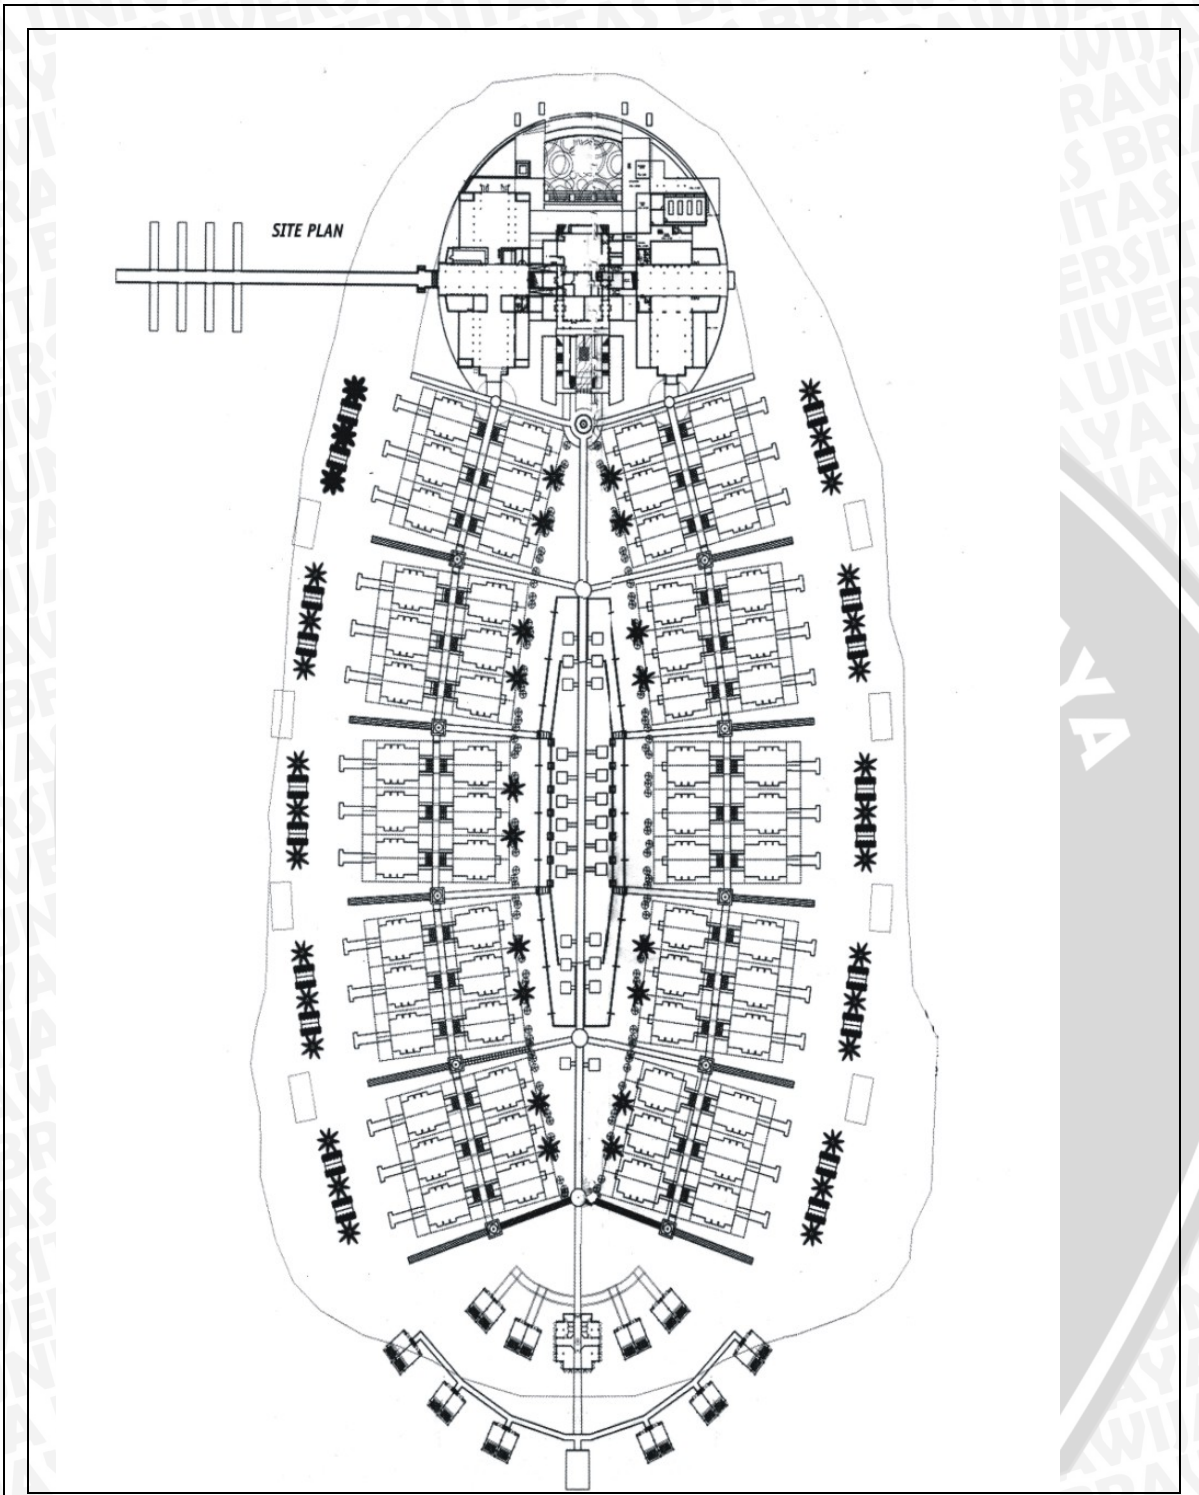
Eksterior pada kawasan dengan fasilitas kamar, kolam renang, restaurant, serta ponton.
